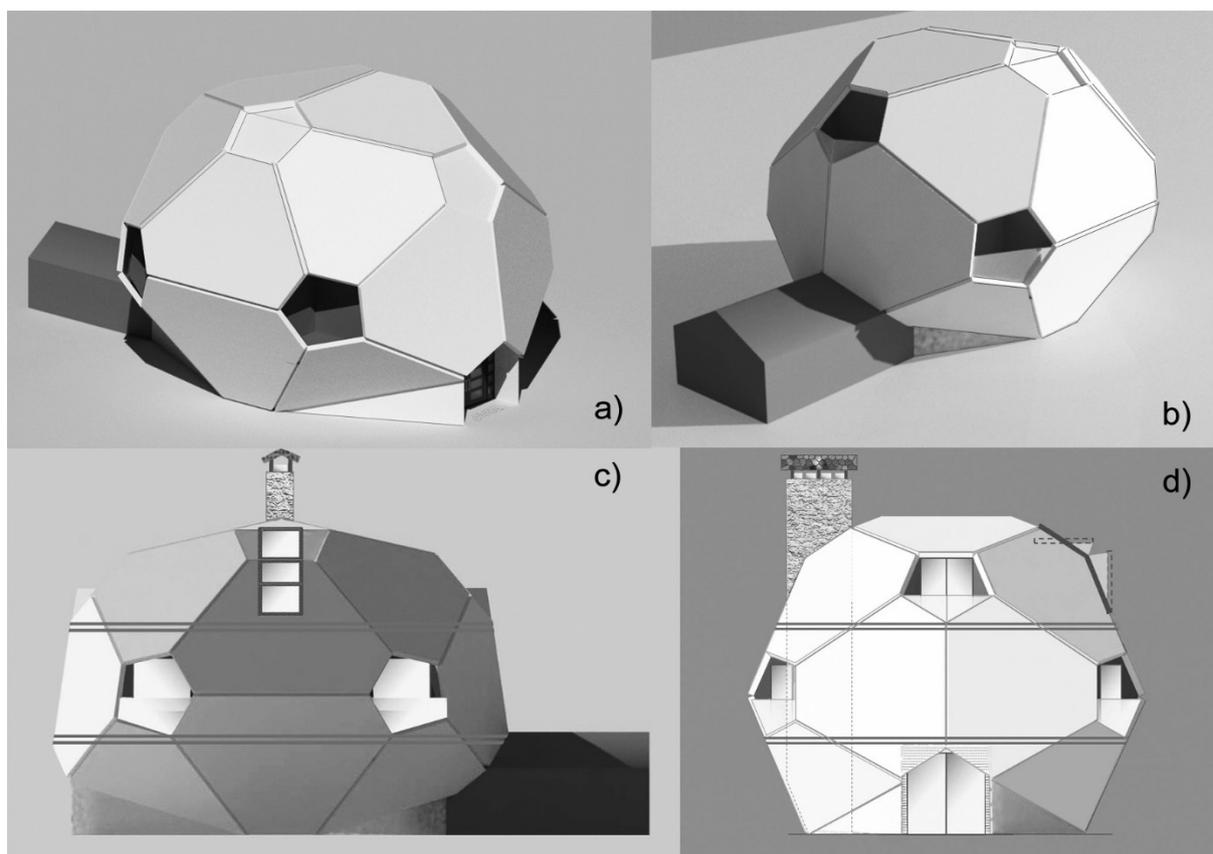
3D-моделирование наружной формы двухэтажного дома с мансардой в виде овоидного геокупола: а) «утопленная» входная группа с «козырьком»; б) на 2-м этаже – 4 балконные ниши с навесами, с) 2 балкона мансарды с двух сторон и сверху накрыты свесами панелей крыши; д) колонна дымоходов и вентканалов.
